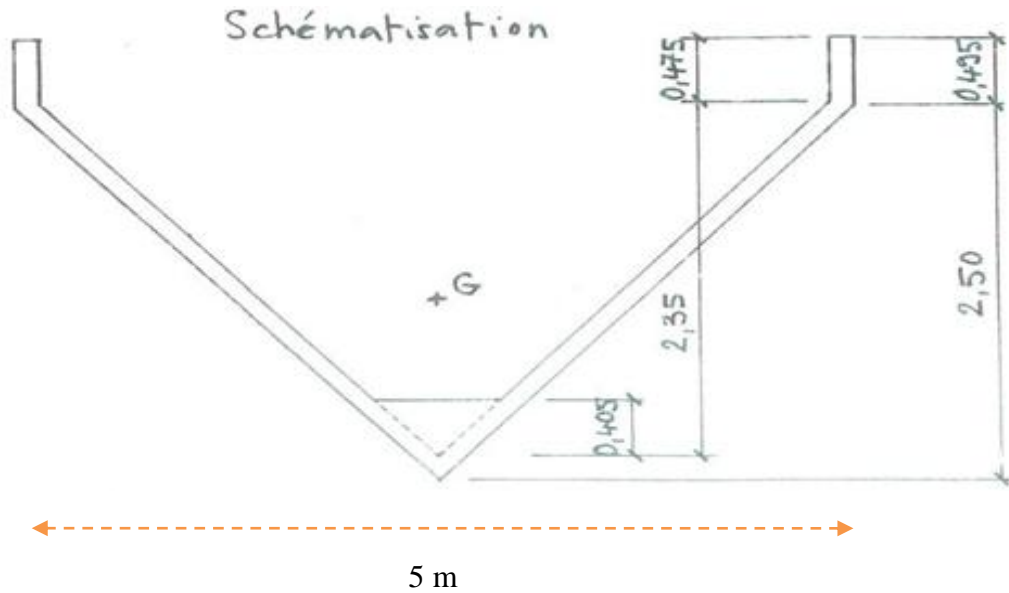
Section d'une onde de la couverture plissée à l'enracinement sur la poutre
